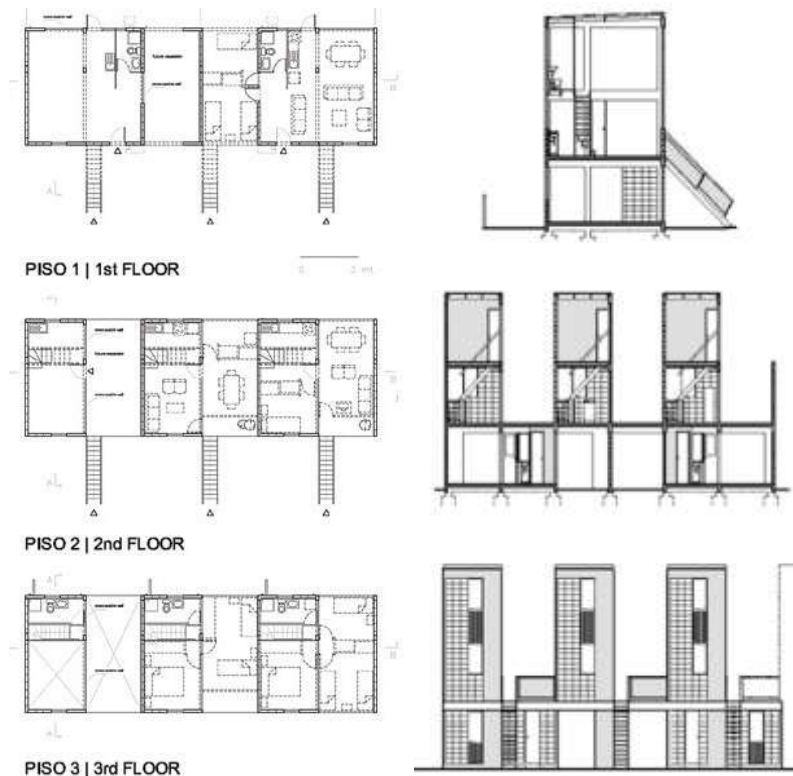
IKTCN magazine (2014). Plantas, Cortes y fachada de la Quinta Monroy
